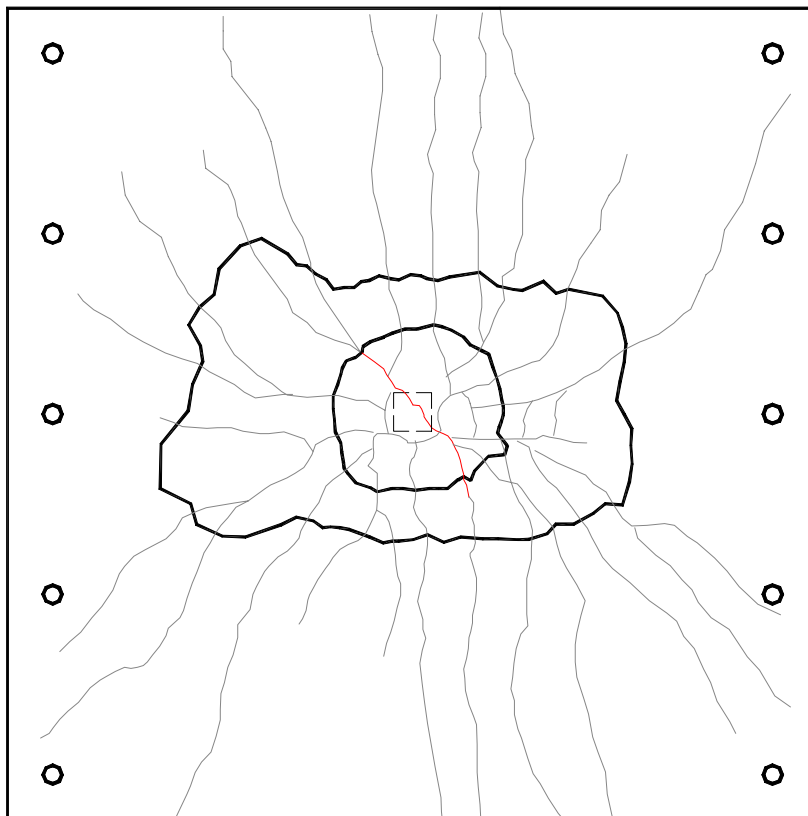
Mapa de fissuração da laje L1B
